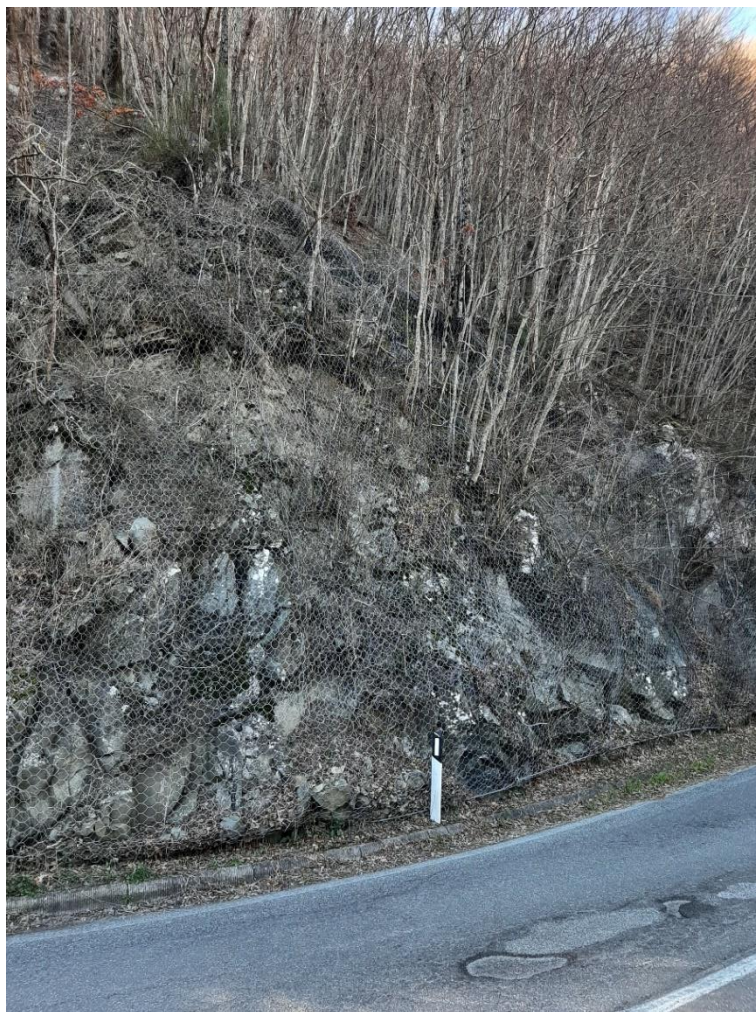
Stralcio 1, Foto di dettaglio della parete rocciosa
